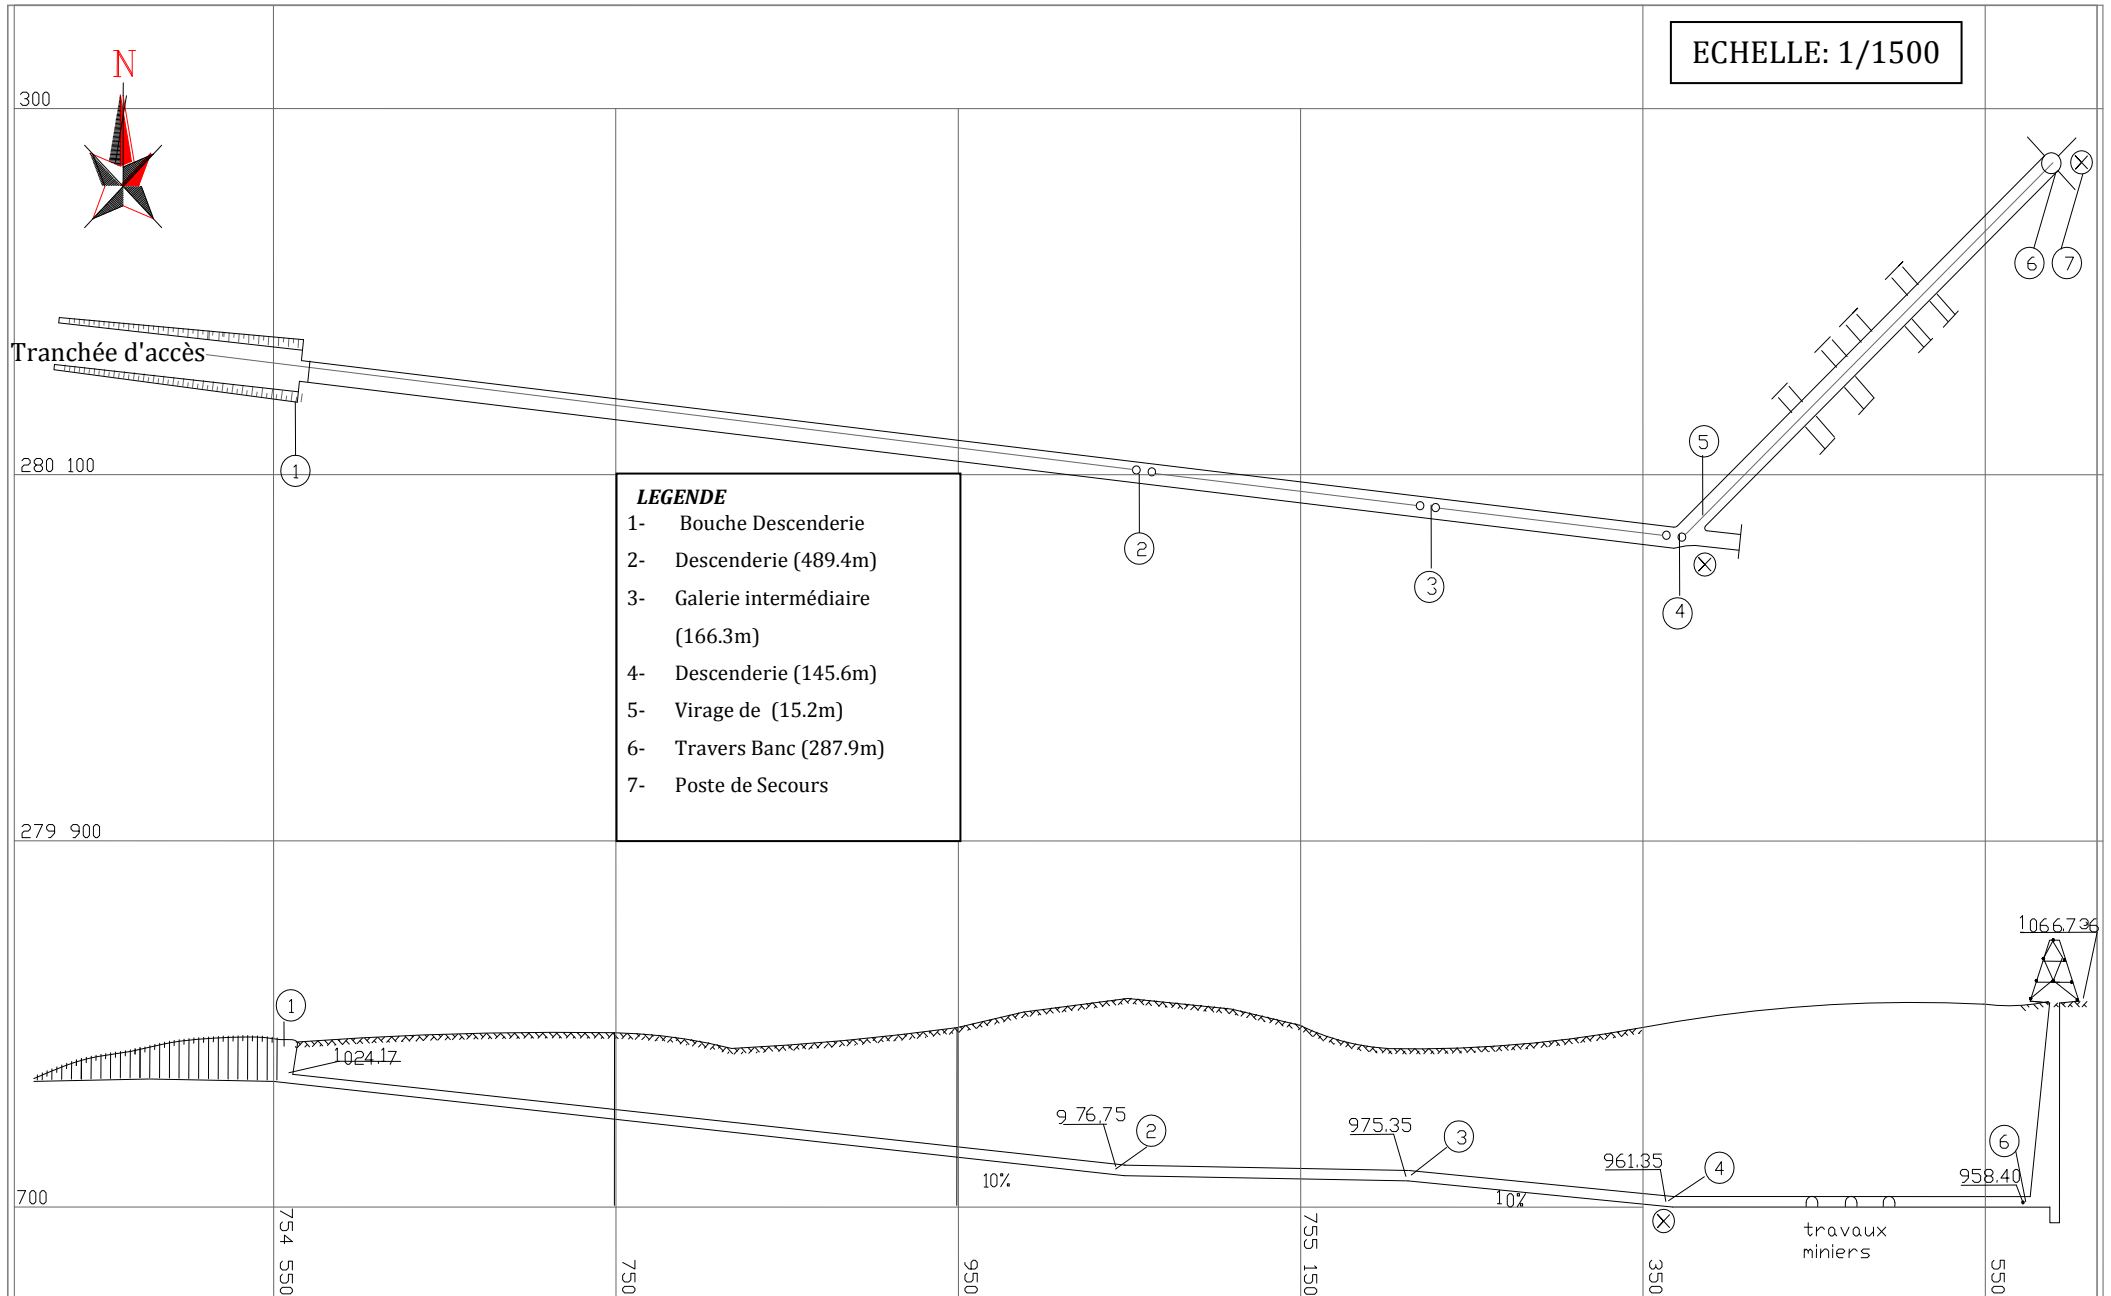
Plan et coupe des travaux d'ouvertures de la mine de Chaâbet el Hamra (1221.4m)
